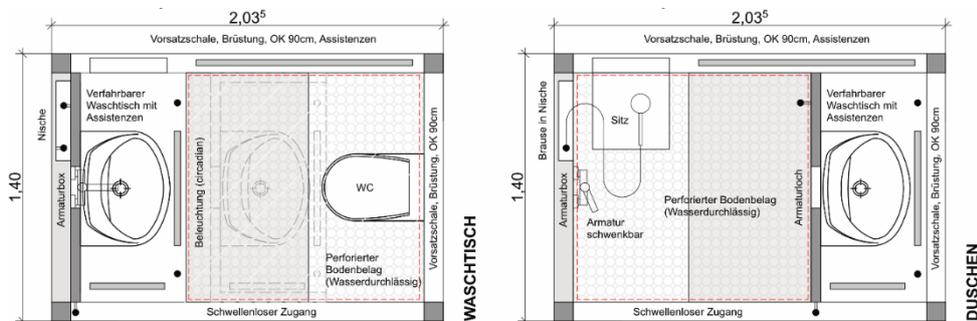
Grundrissdarstellung, Konzeptstatus-04
